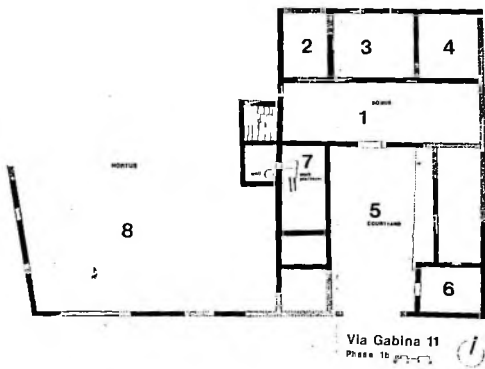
Idem. Planimetria da fase 1b (Widrig,1983, fig. 3).
